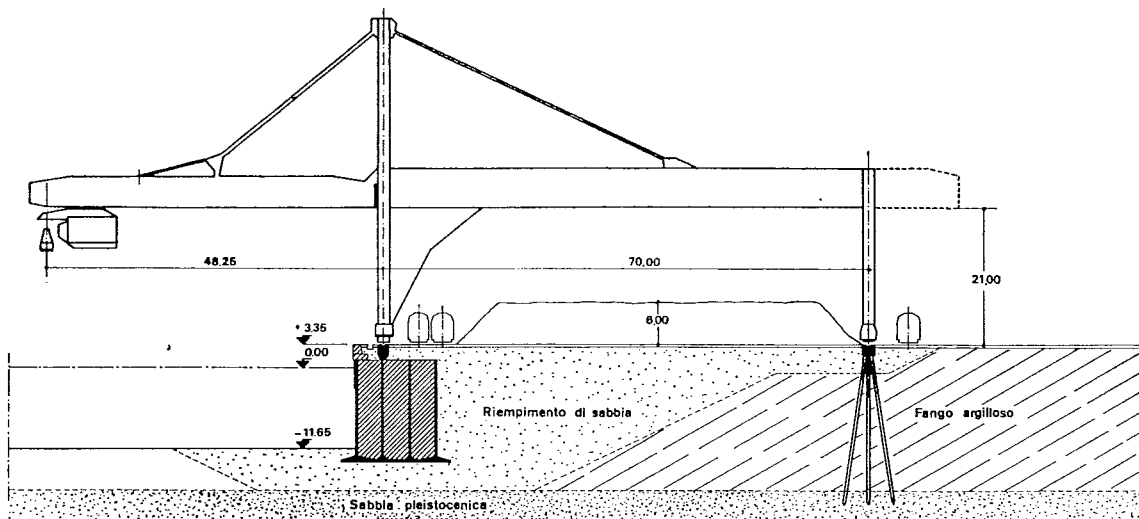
PORTO DI ROTTERDAM. Banchina a cassoni nel bacino Waalhaven - 1945-48.
